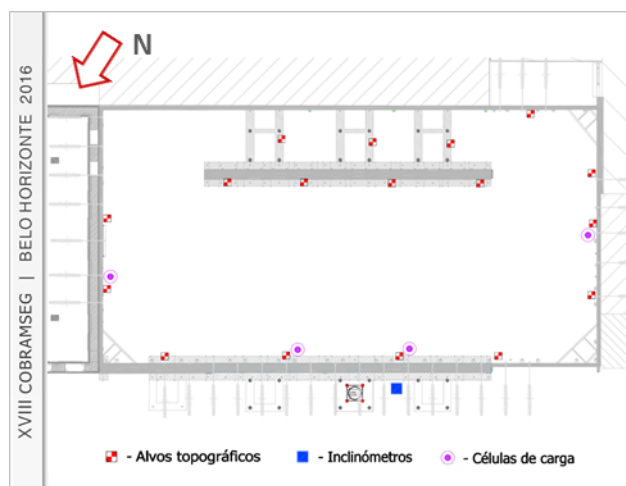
Planta de localização dos dispositivos de observação instalados, no âmbito do P.I.O.
